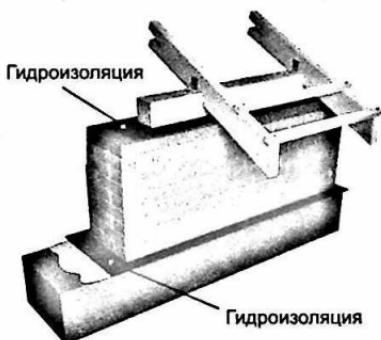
Гидроизоляция несущих стен от капиллярной влаги
